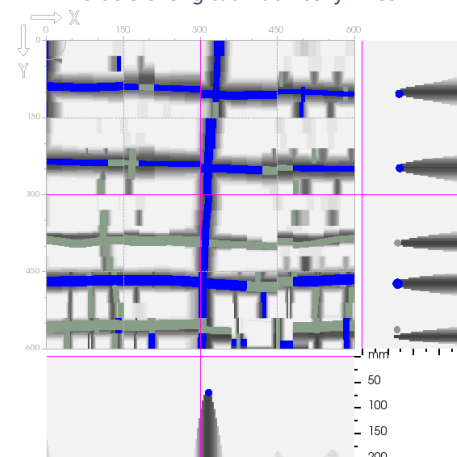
Poutre Pt03 – Travée 4 à mi-travée
